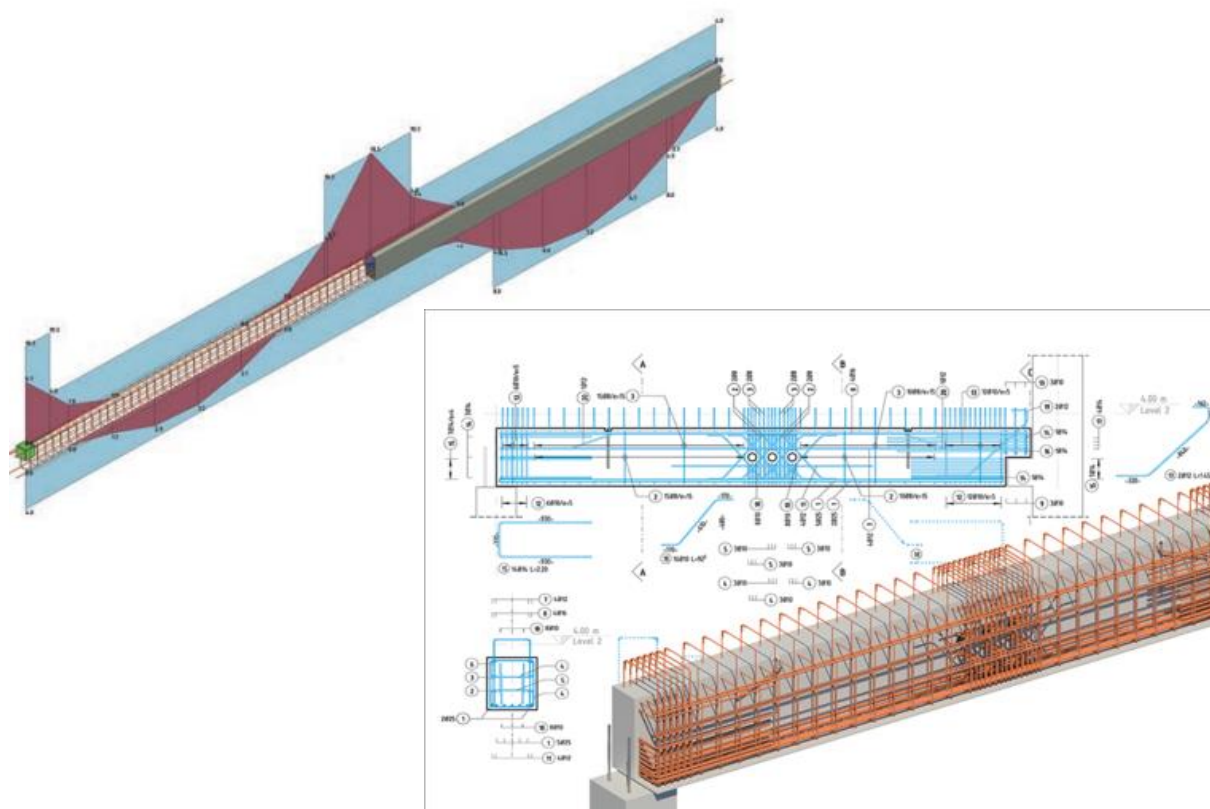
Gegenüberstellung erforderliche und eingelegte Bewehrung in Revit sowie automatische generierter Bewehrungsplan mit 3D-Visualisierung [34]
